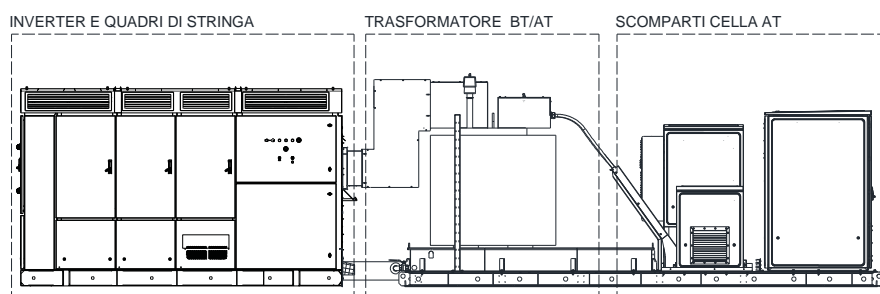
Vista frontale dell'Inverter insieme allo SKID
